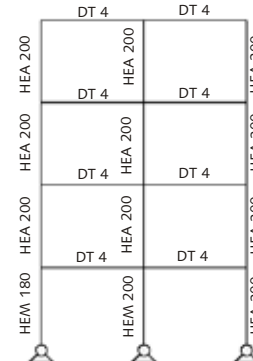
Grundriss Rahmen II - Haus 2
